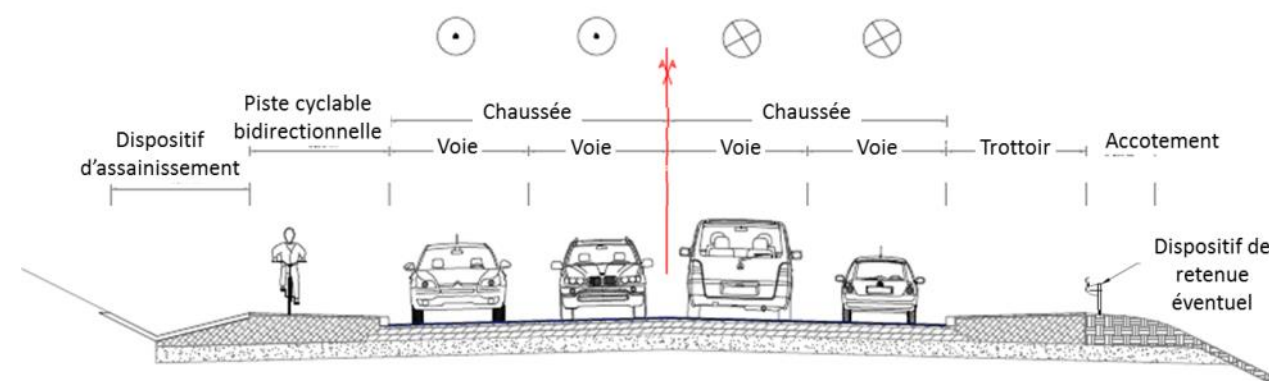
Profil en travers type de la RD 128 au droit de l'ouvrage de franchissement.
